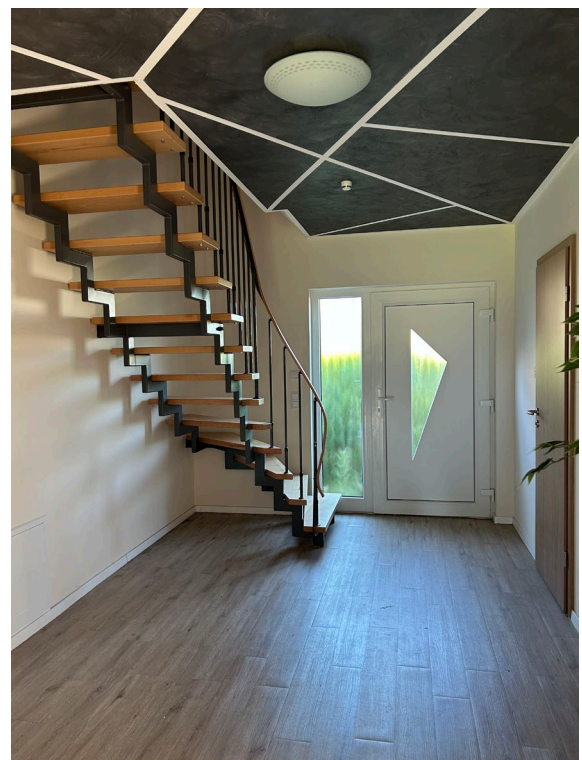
Erdgeschoss, Ansicht Flur mit Geschosstreppe und Hauseingang
